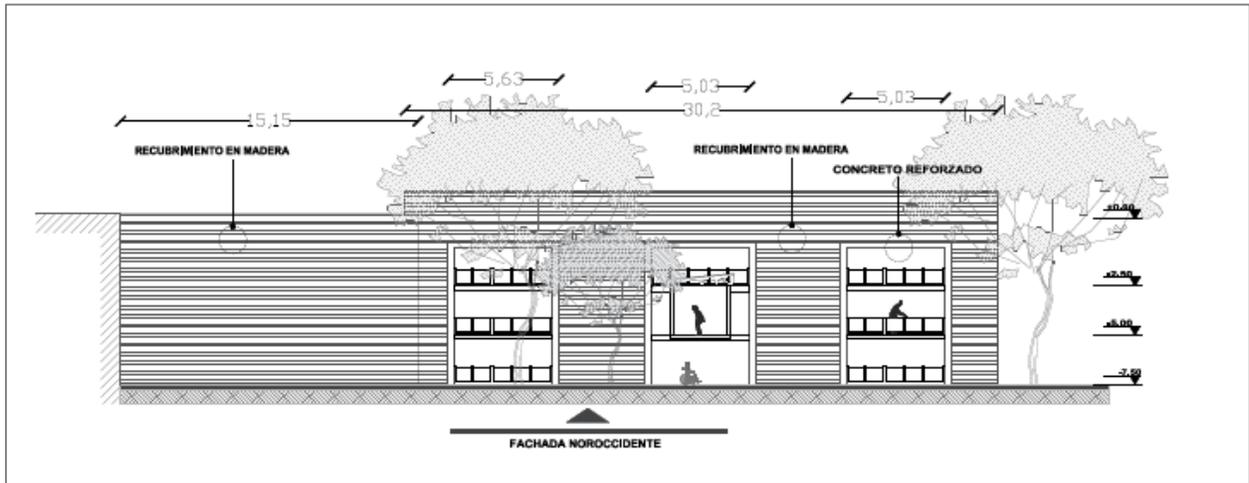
Fachada Noroccidente Edificio 2 (Rubiano, 2020)
